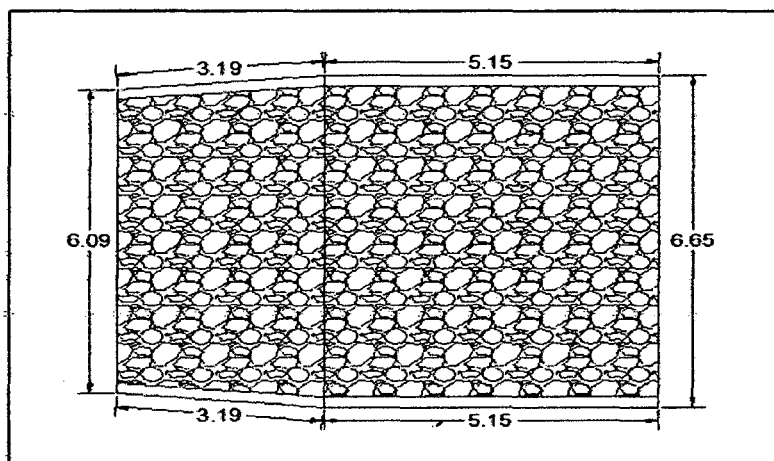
Planos de detalle del Emboquillado km 118+490. Fuente: Datos de Obra.
